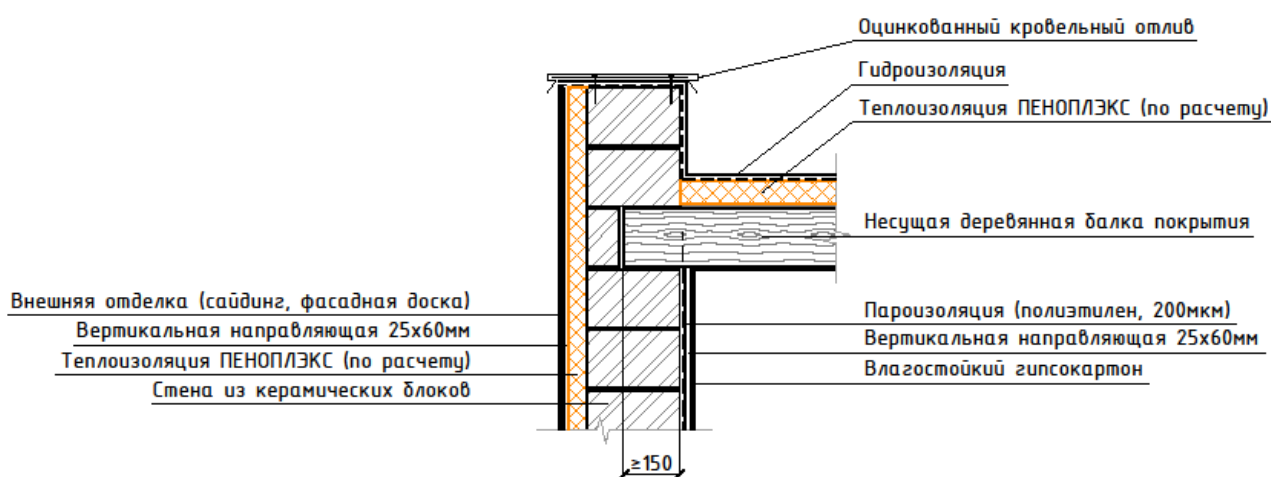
Схема примыкания теплоизолированной стены из керамических блоков к конструкции плоской кровли.
